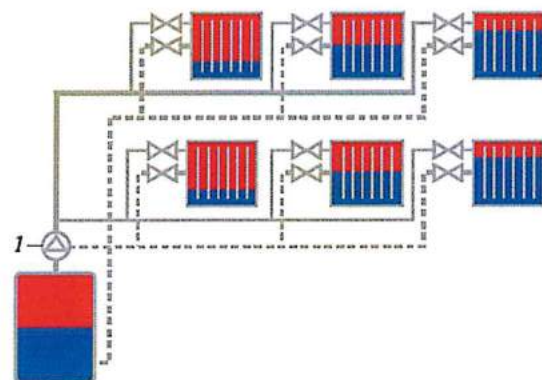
Heizungsanlage Hydraulisch nicht abgeglichen
